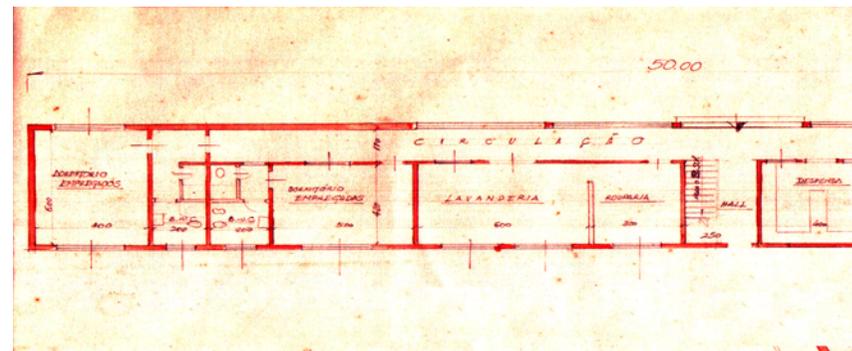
Planta baixa da área de serviço. Fonte: projeto original cedido pelo Engenheiro Romeu Paulo da Costa.
